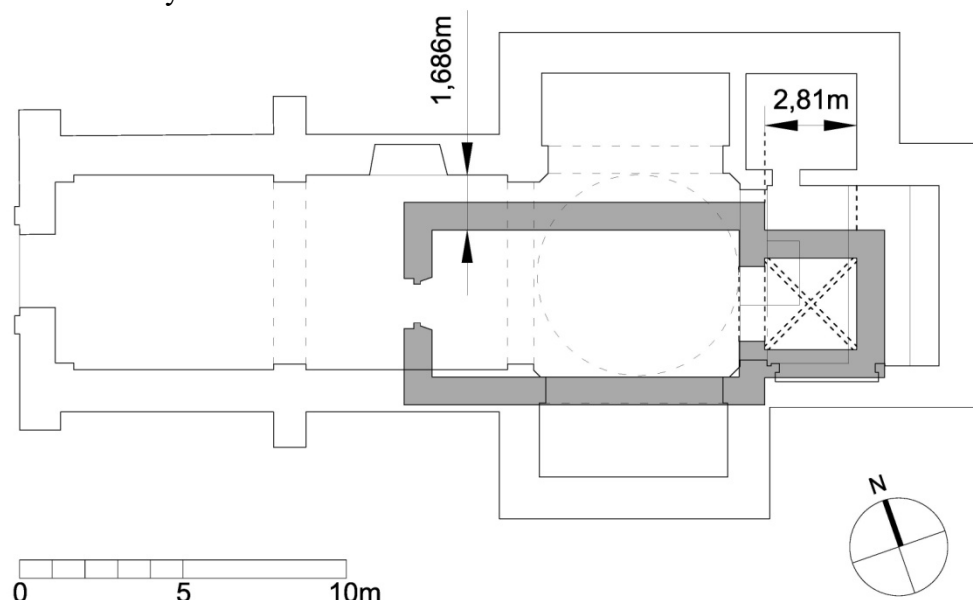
Planta conjetural del primitivo santuario gótico de las Virtudes. Plano del autor.
